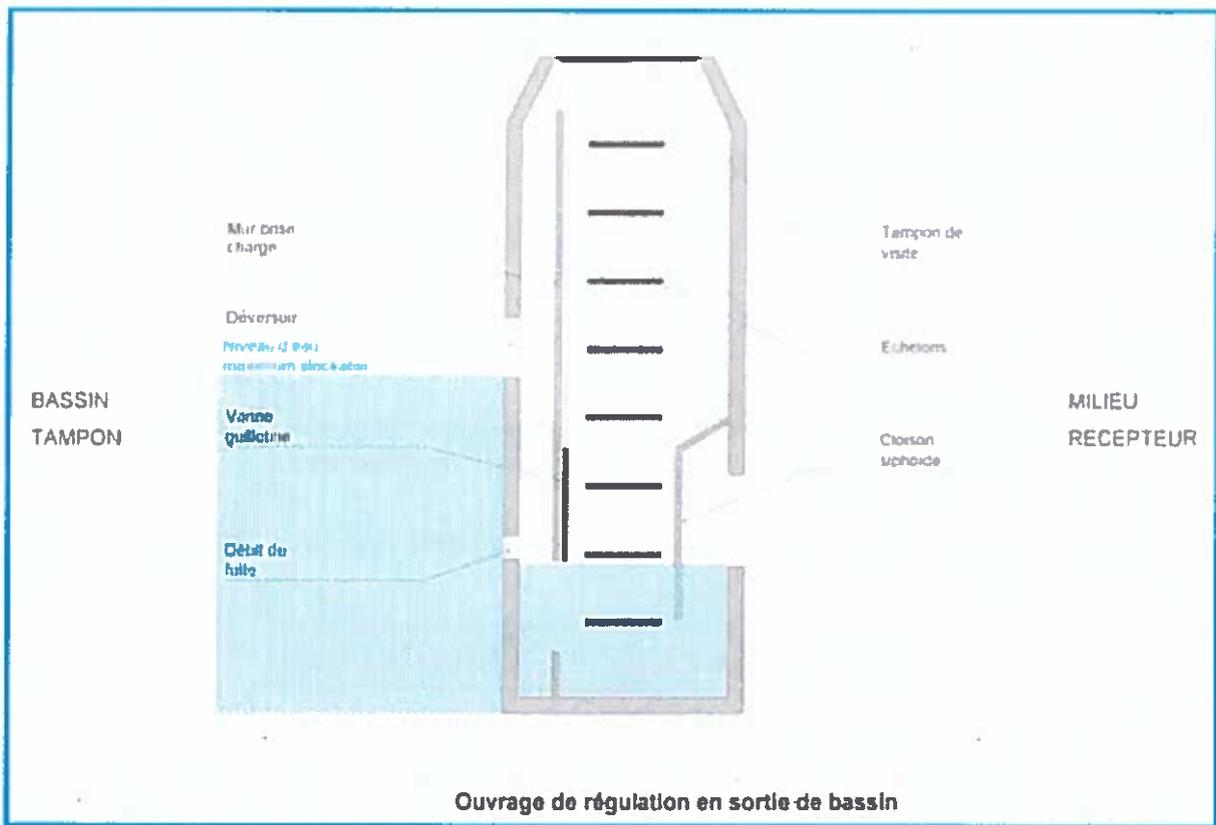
Coupe de l'ouvrage de stockage-régulation
